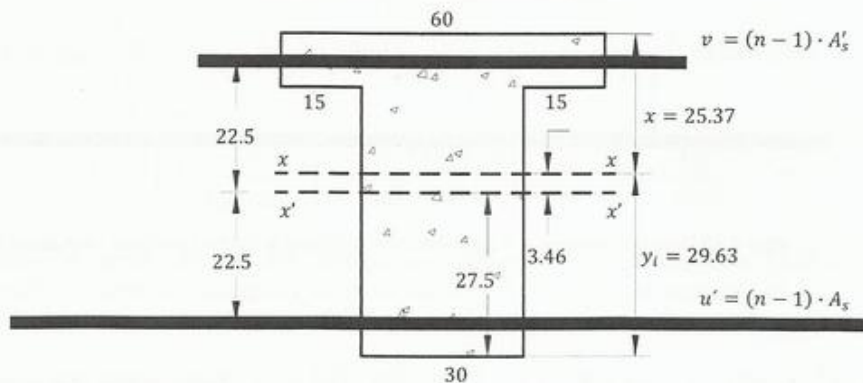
Viga del ejemplo 4.1 Sección T de concreto armado no agrietada (con acero)
